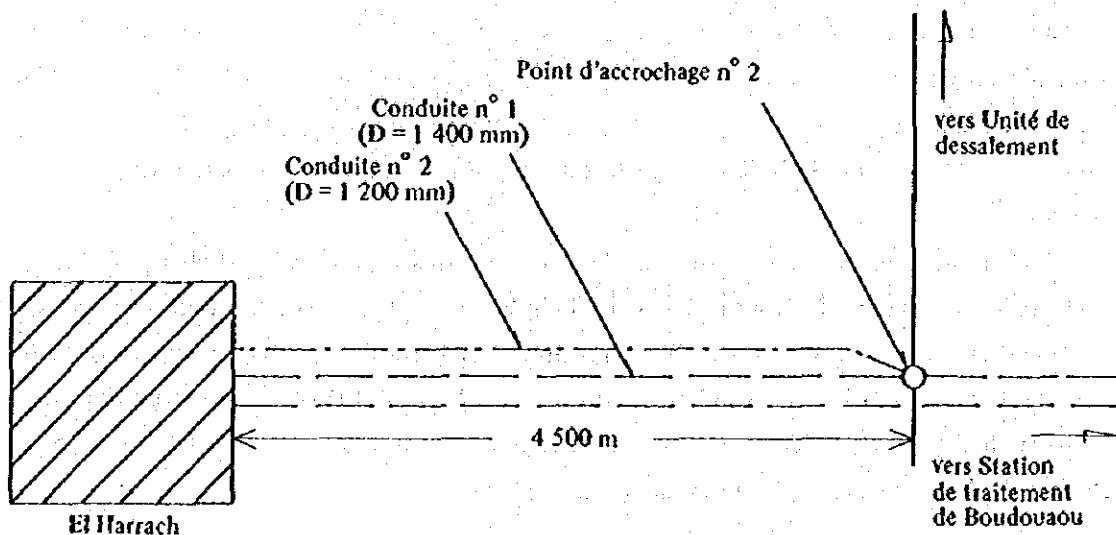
Conduite entre El Harrach et Point d'accrochage n° 2
